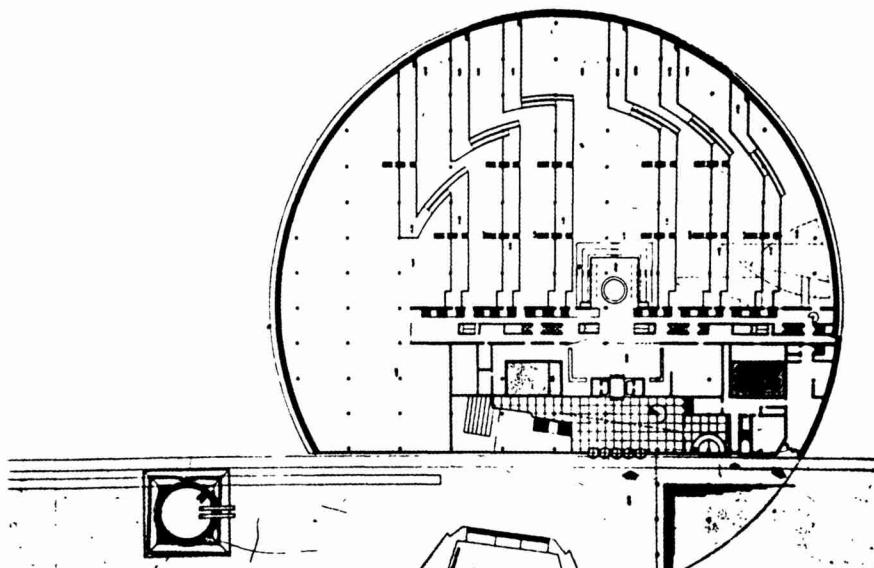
Alexandria, Grundriß, Erdgeschoß
